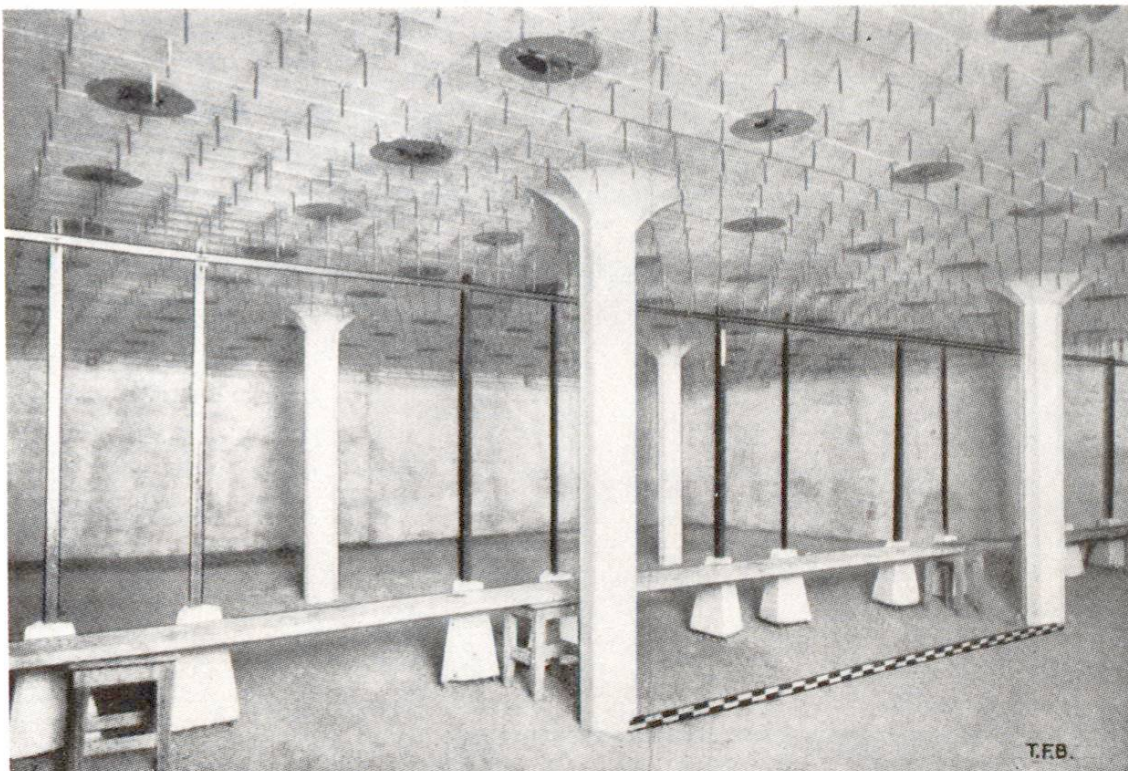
Parement inférieur d'une dalle-champignon d'essai avec points de mesure
